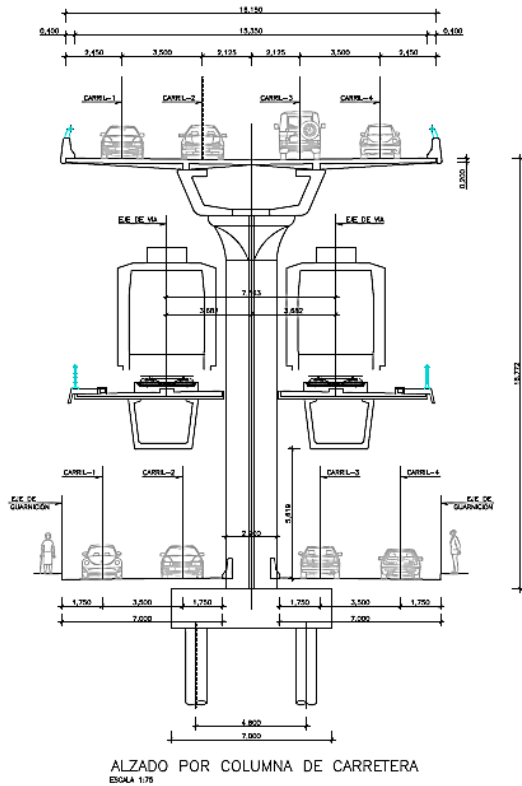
Sección en Viaducto prefabricado de dos pisos en zona urbana
